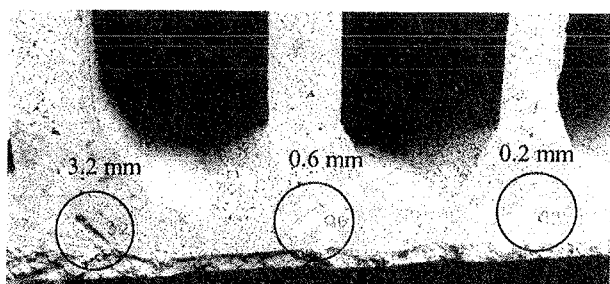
Particolare delle armature di precompressione e rientro nella zona di testata.
